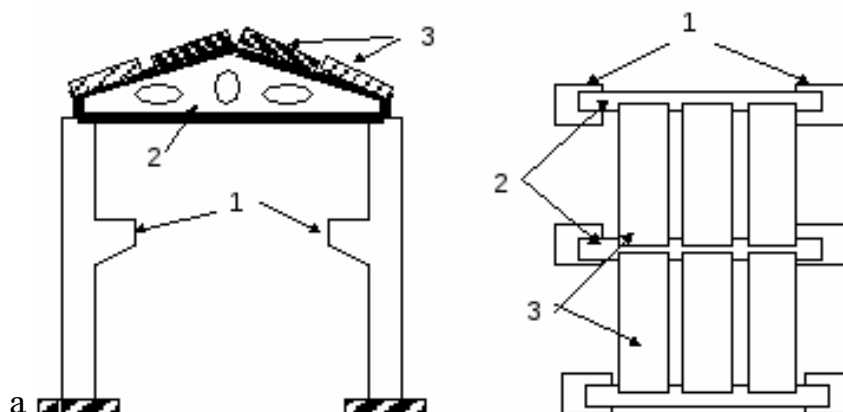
Железобетонный каркас верхнего строения насосной станции:
